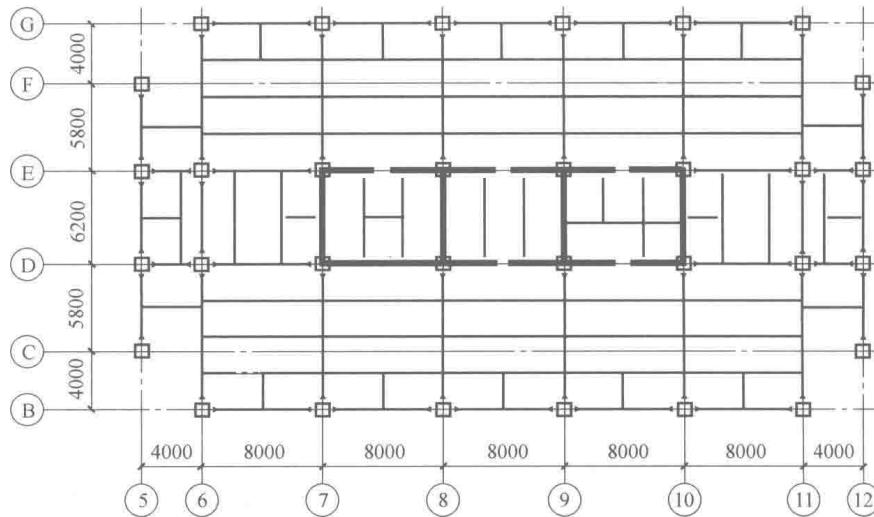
北京长富宫中心饭店钢框架-混凝土剪力墙结构标准层平面布置图
